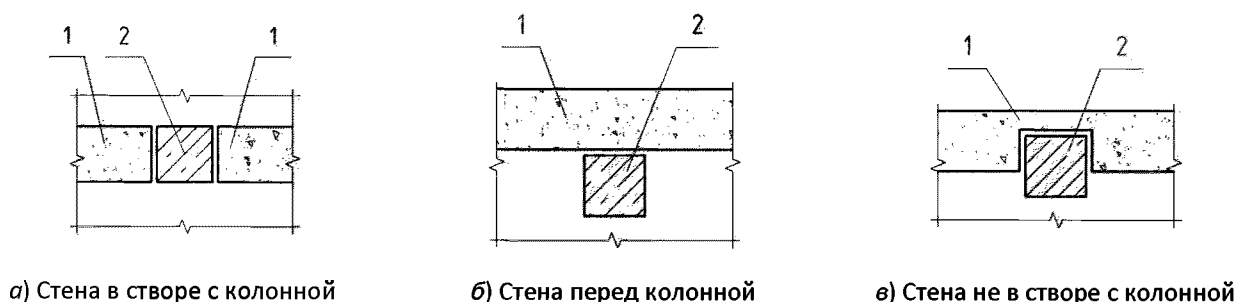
Схемы расположения стен по отношению к вертикальным конструкциям несущего каркаса здания
